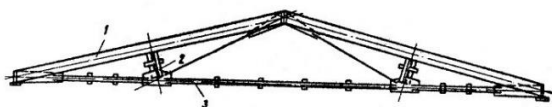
Сталежелезобетонная ферма треугольного очертания. 1 - Верхний пояс, 2 - Решетка, 3 - Нижний пояс
